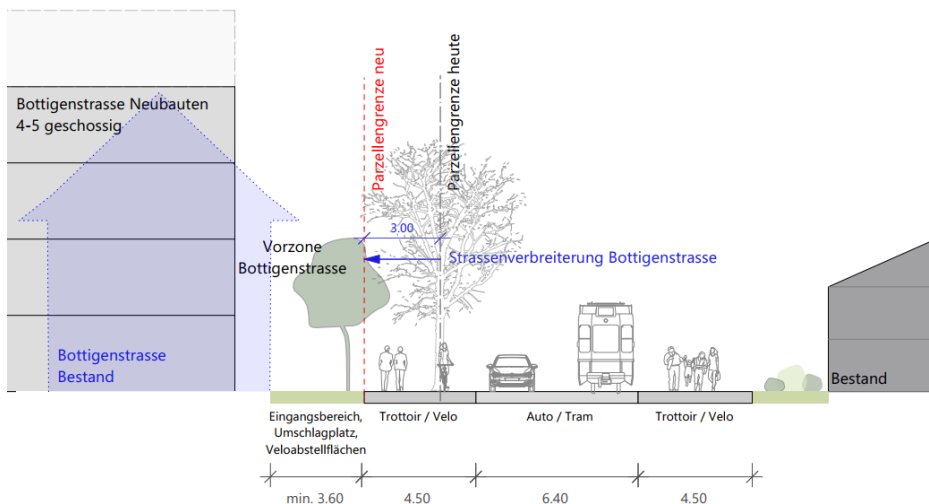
Schemaschnitt Strassenverbreiterung Bottigenstrasse bei Neubau
